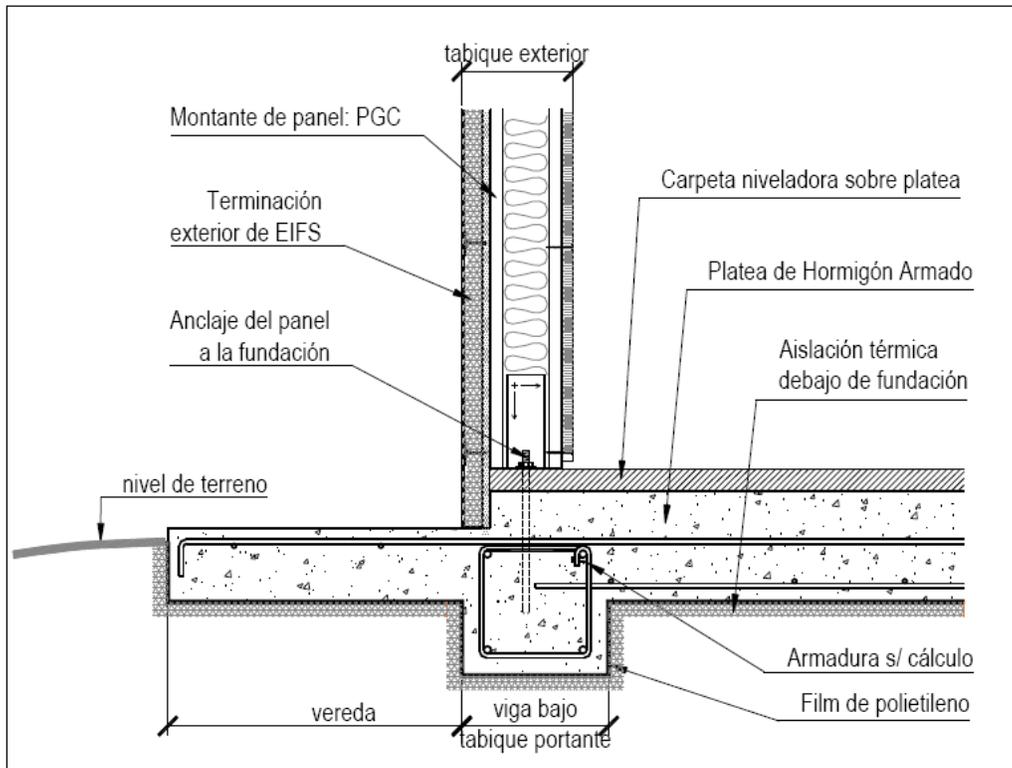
⁽¹¹⁾. Montaje Estructura Steel Framing sobre losa de H°A°
